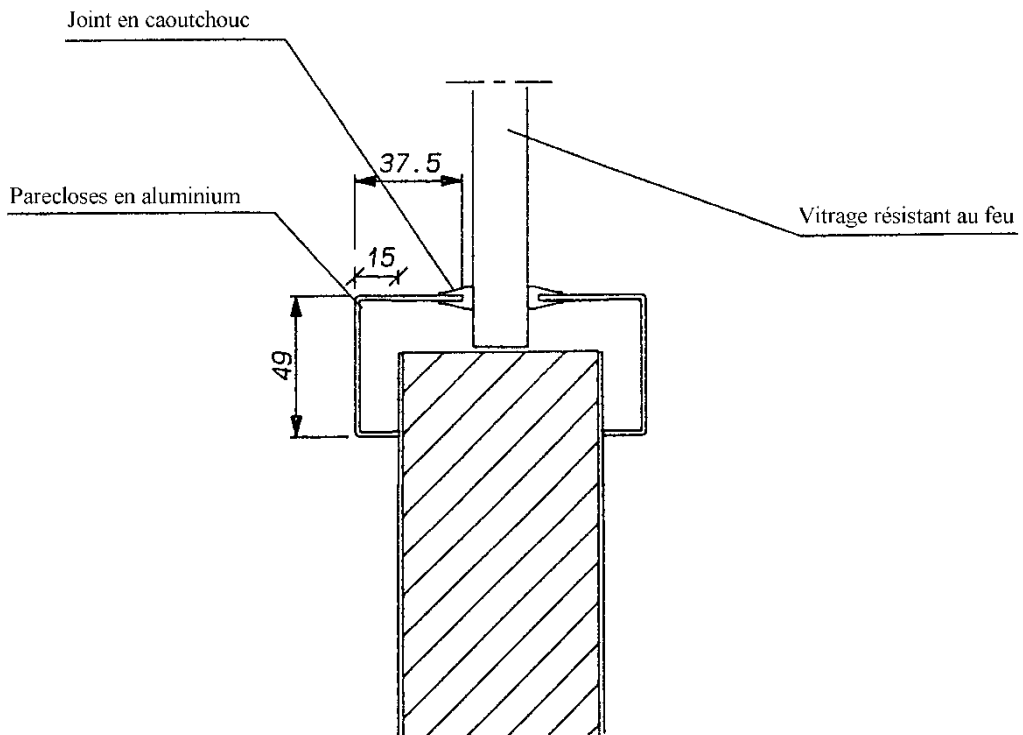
bis : Coupe du vantail à l'endroit des parecloses
